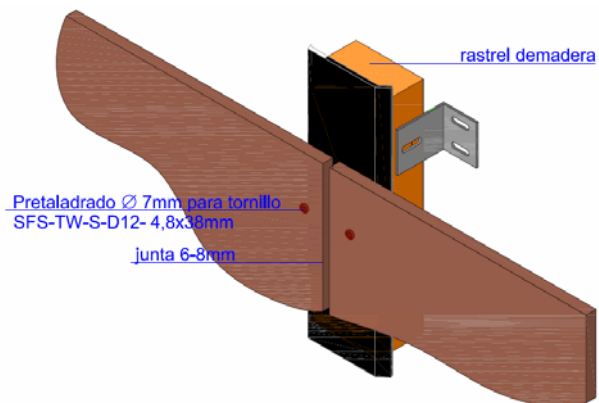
SUBESTRUCTURA METÁLICA
